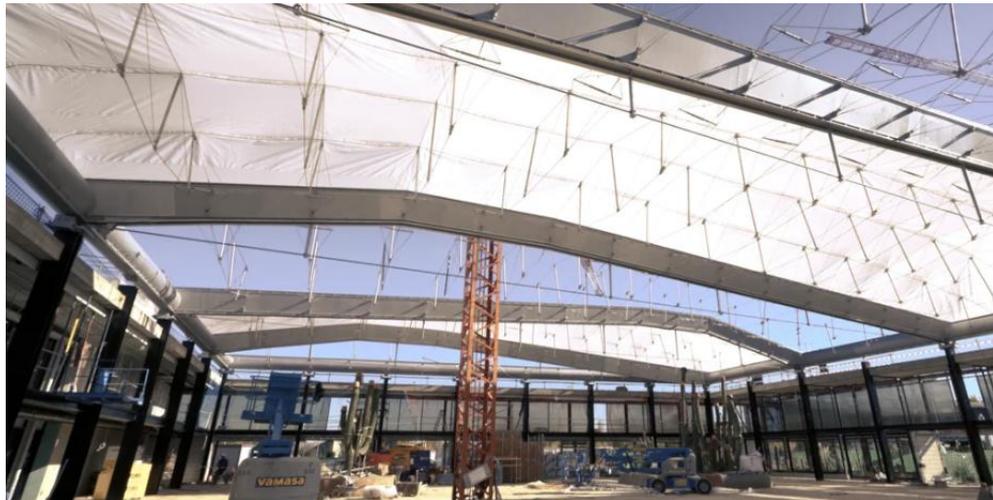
Cobertura da Cidade do Deserto. Fonte: Site Garciagerman Arquitectos
